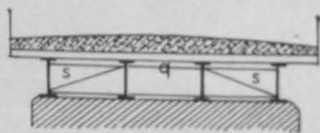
Querschnitt einer Straßenbrücke mit mehr als zwei Hauptträgern.
